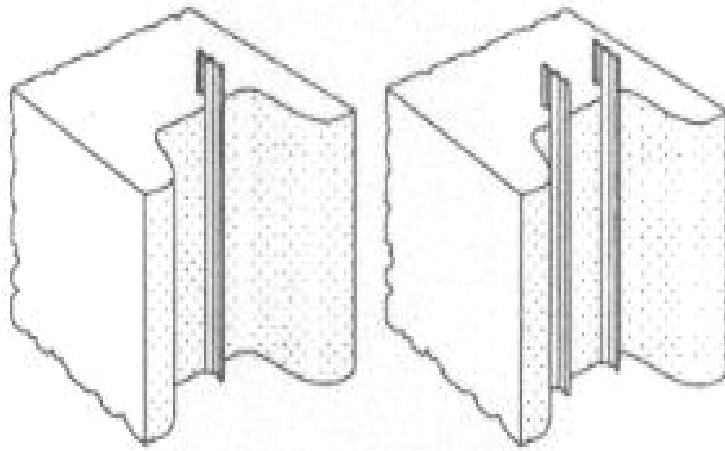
ขั้นตอนการก่อสร้าง Diaphragm Walls
